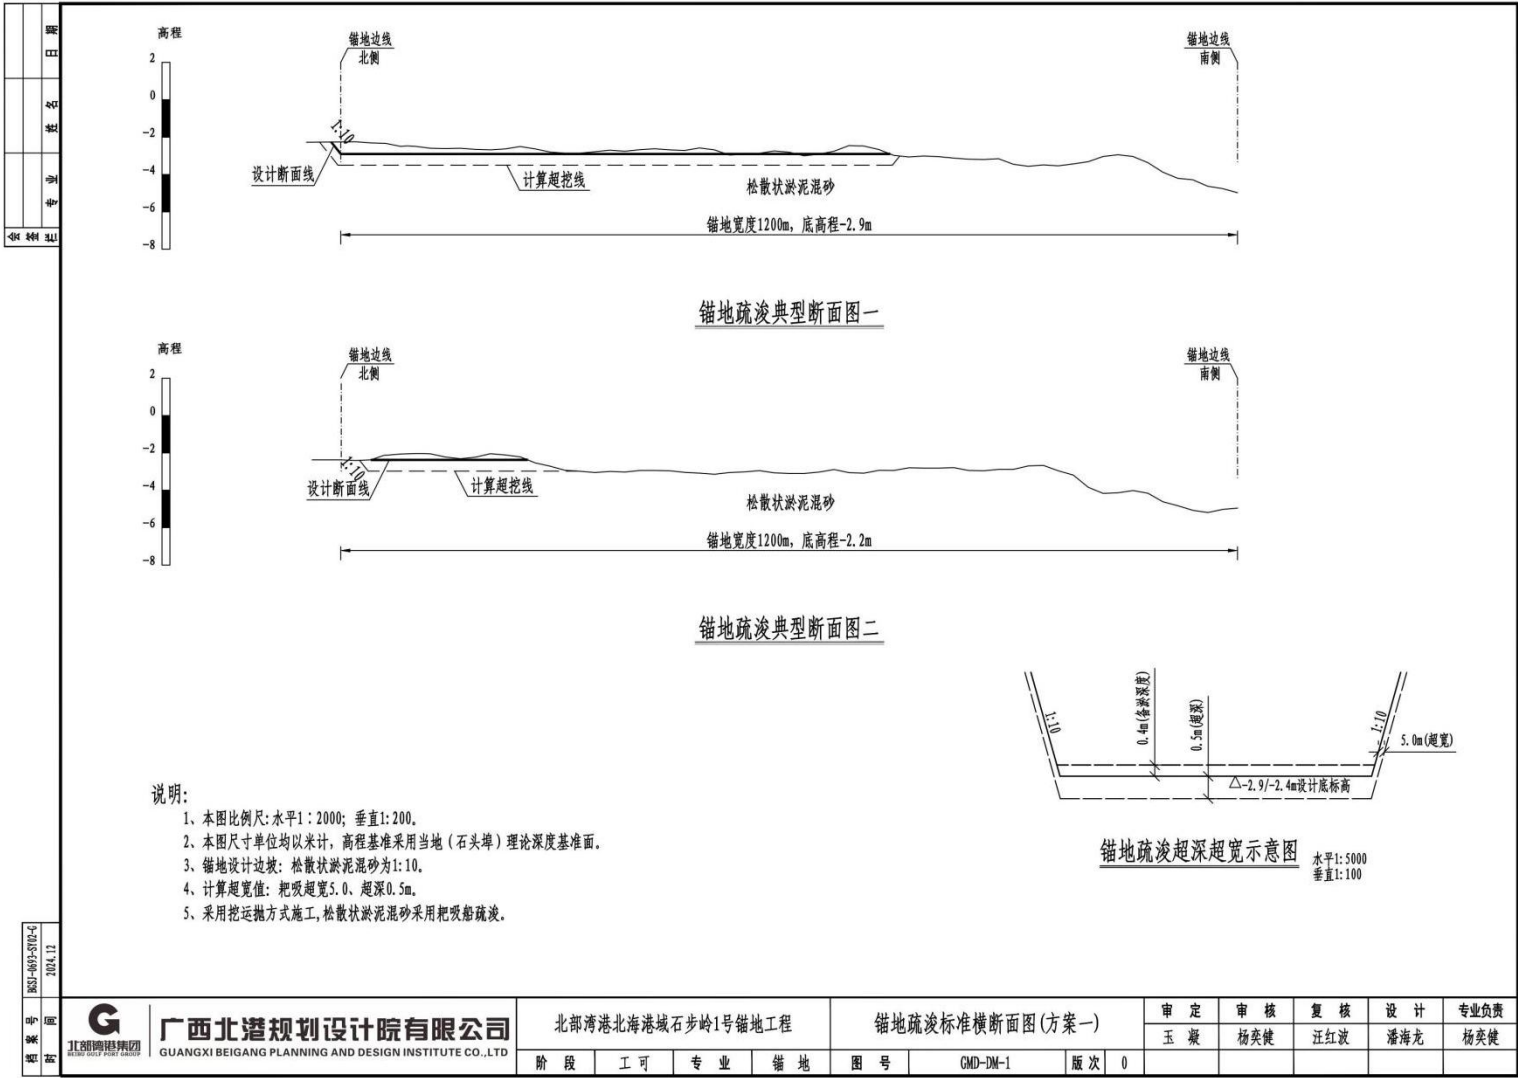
项目锚地疏浚标准横断面示意图-1
